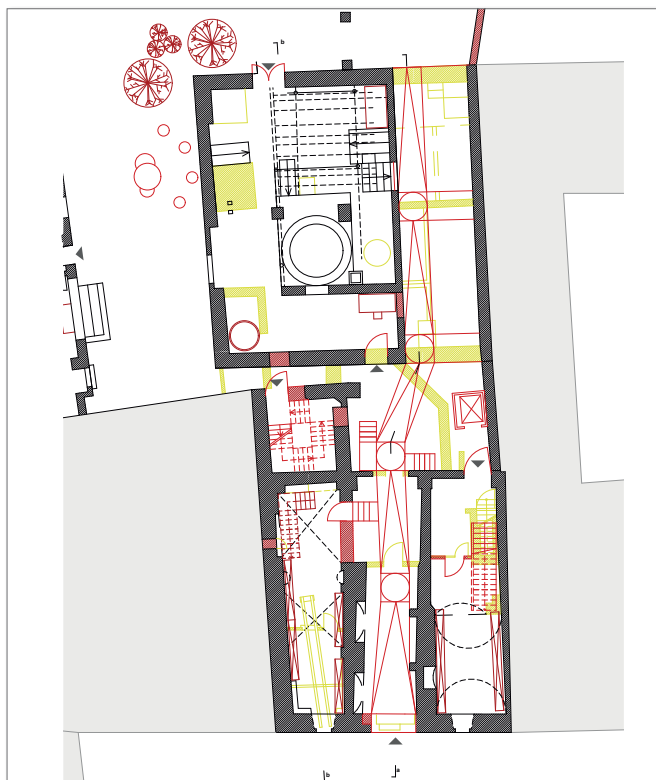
Malz- und Sudhaus, Erdgeschoss
